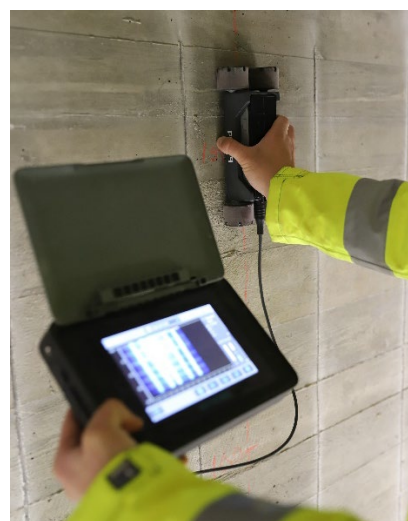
Förslag till tillståndsanalys av spännarmerade betongkonstruktioner
